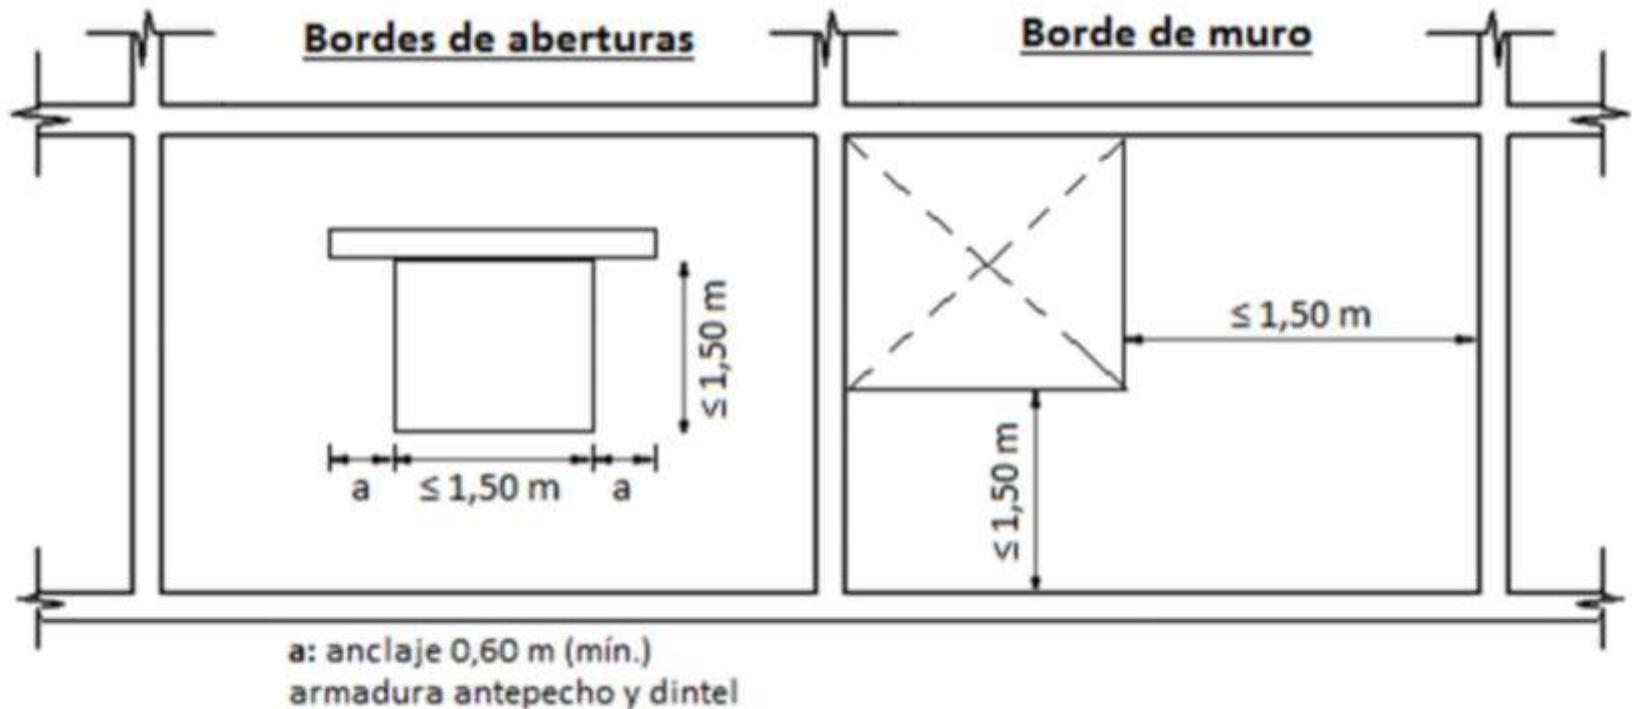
Disposiciones para mampostería encadenada según CCSRM '87
